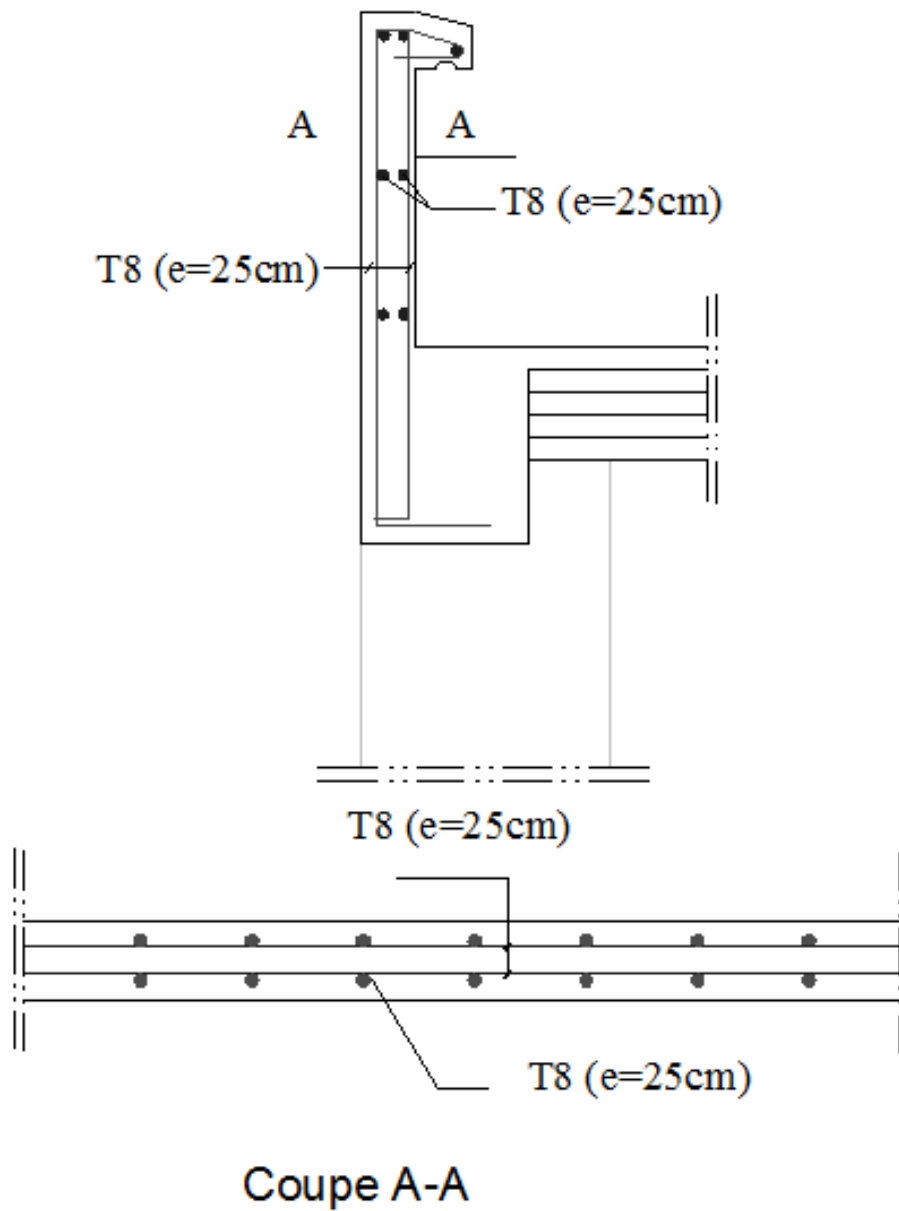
Coffrage et ferrailage de l'acrotère
